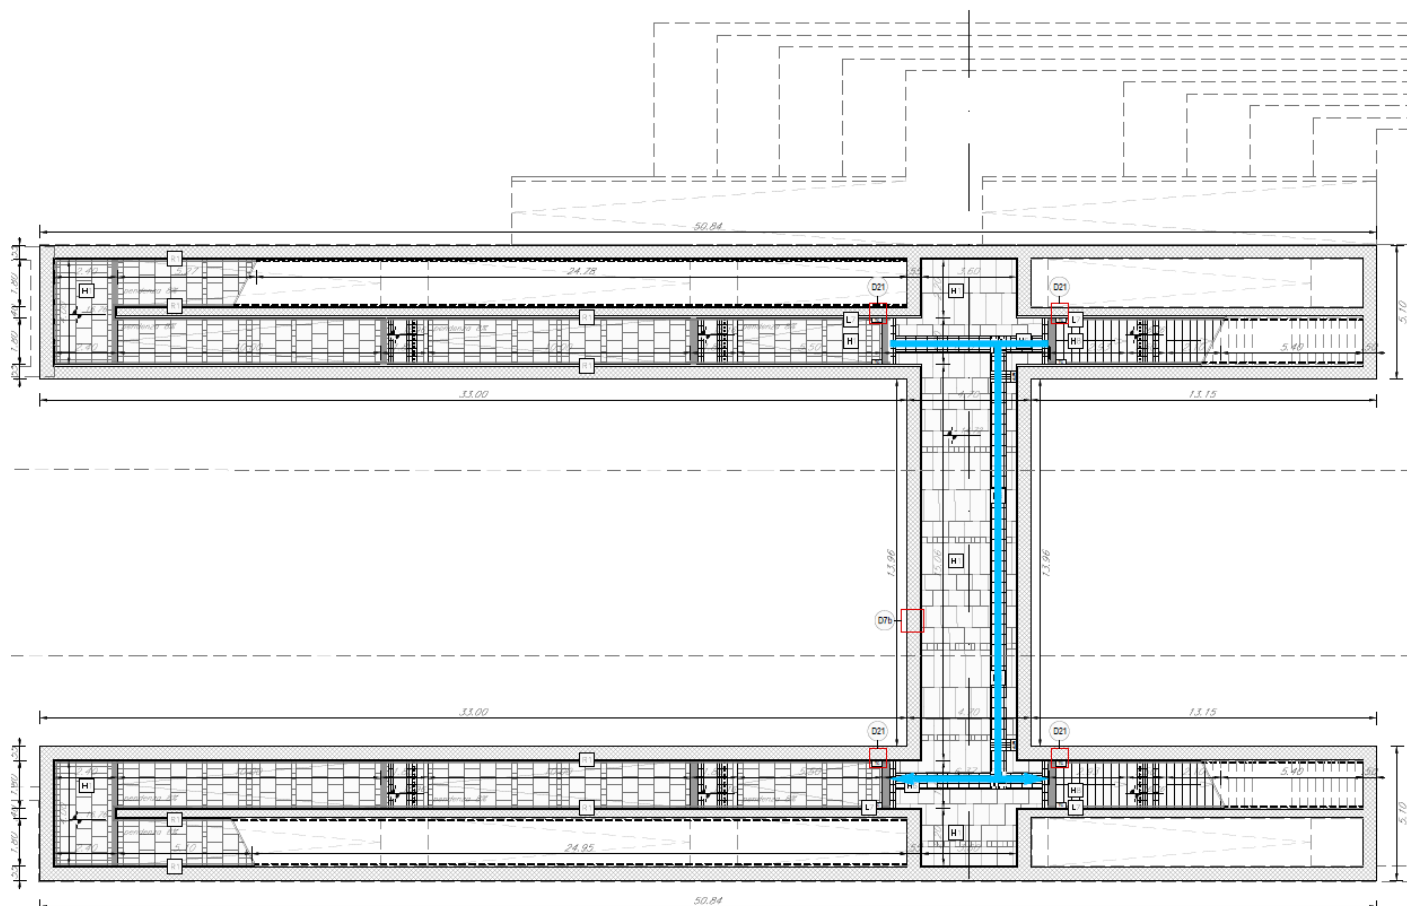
Pianta Quota Sottopasso con individuazione del PPO
